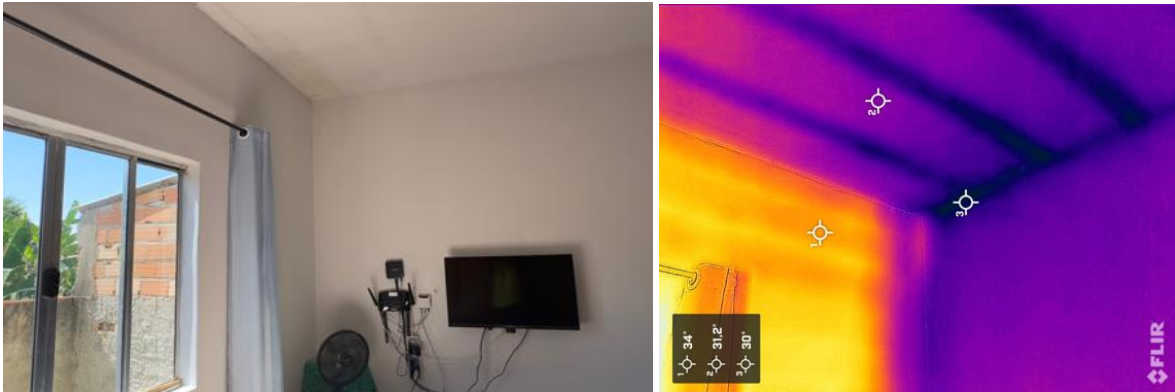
Parede e teto do quarto suíte da edificação 4.
